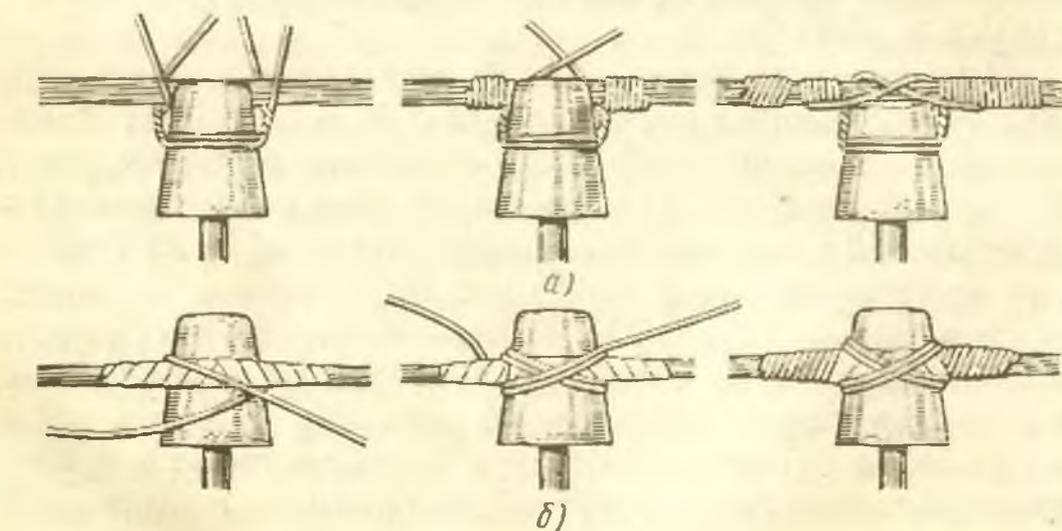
Крепления проводов к изоляторам вязкой: а — головной, б — боковой
